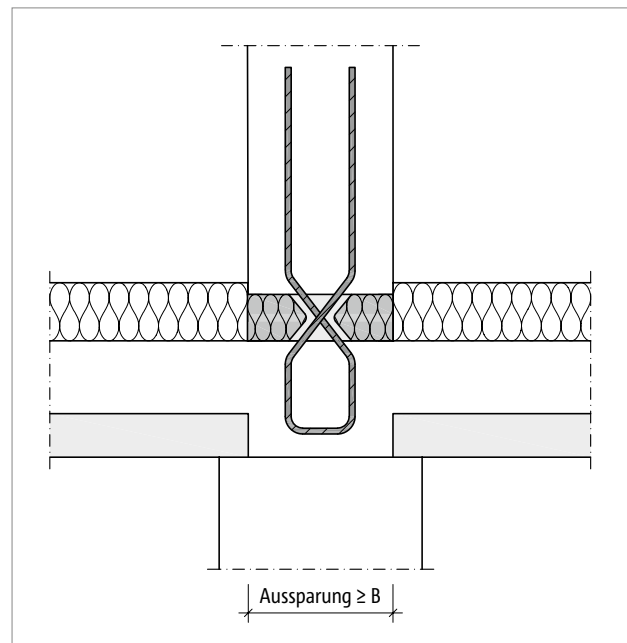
Schöck Sconnex® Typ W: Einbau des Typ W in die Halbfertigteilplatte (Aussparung erforderlich)
